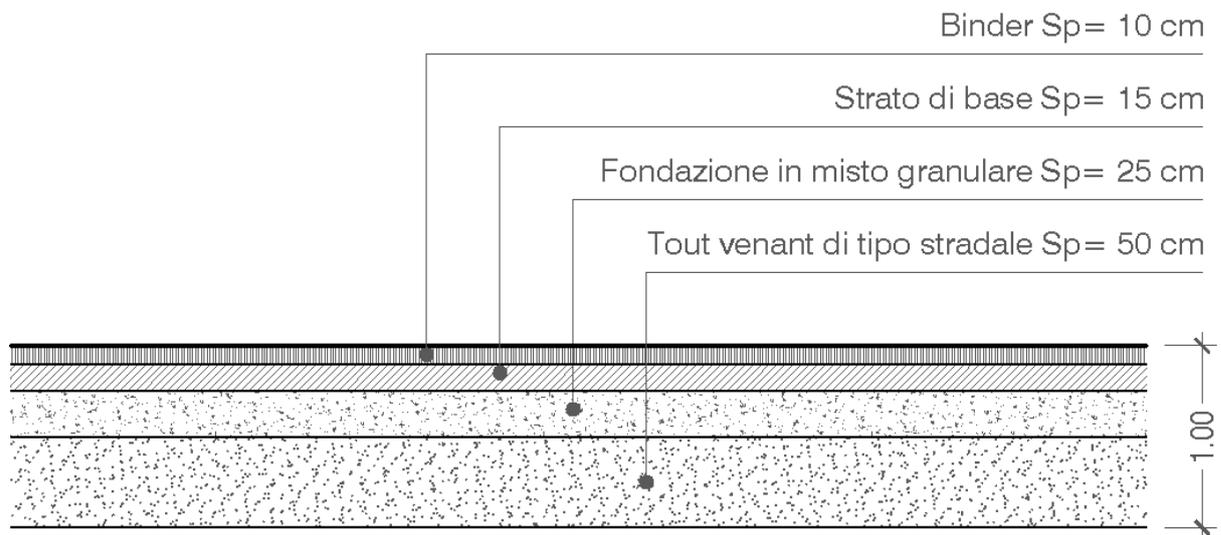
Pacchetto della pavimentazione di tipo flessibile di progetto all'interno del terminal
